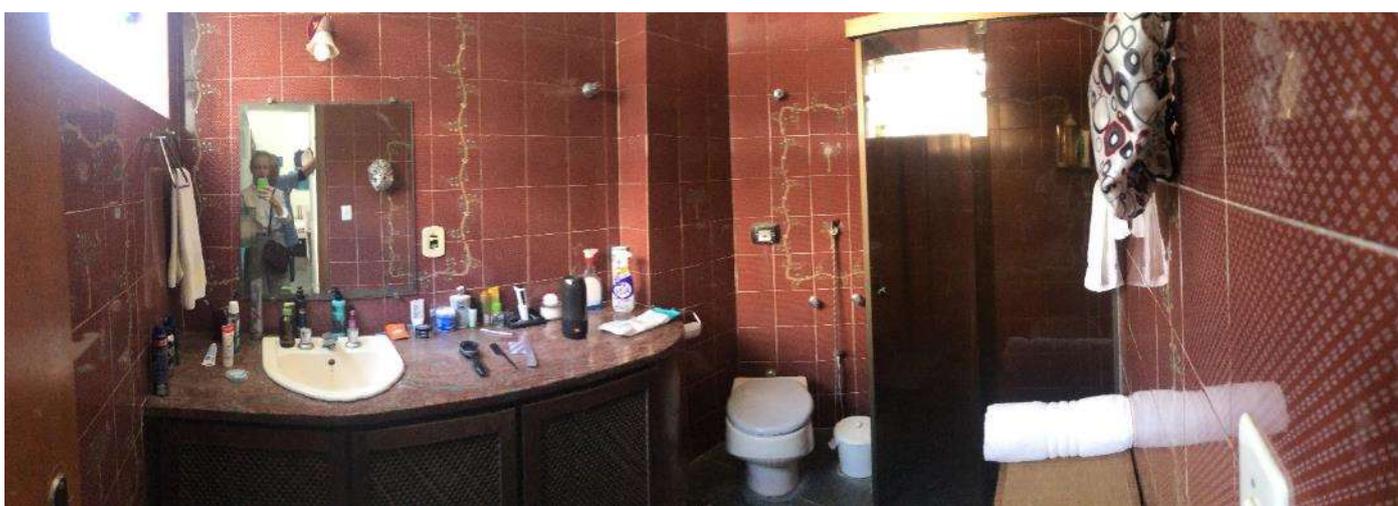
Vista panorâmica Banheiro Suíte 1.
